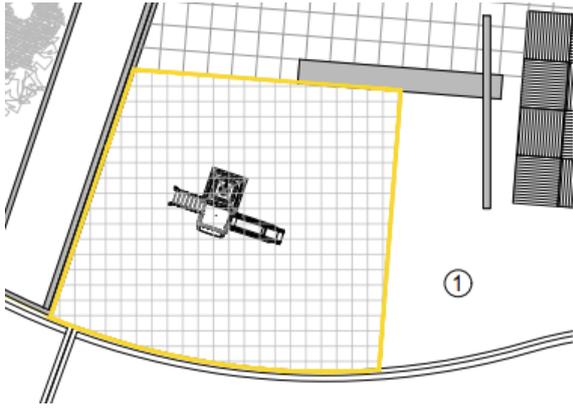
Planta de situação existente (PI 1) | Fonte: autora, 2023 | sem escala
